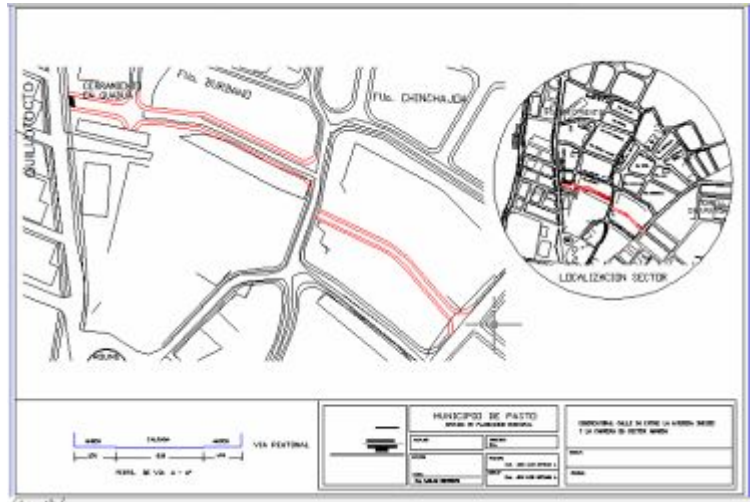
Planta y sección transversal calle 36 entre Avenida Inesco y carrera 26
